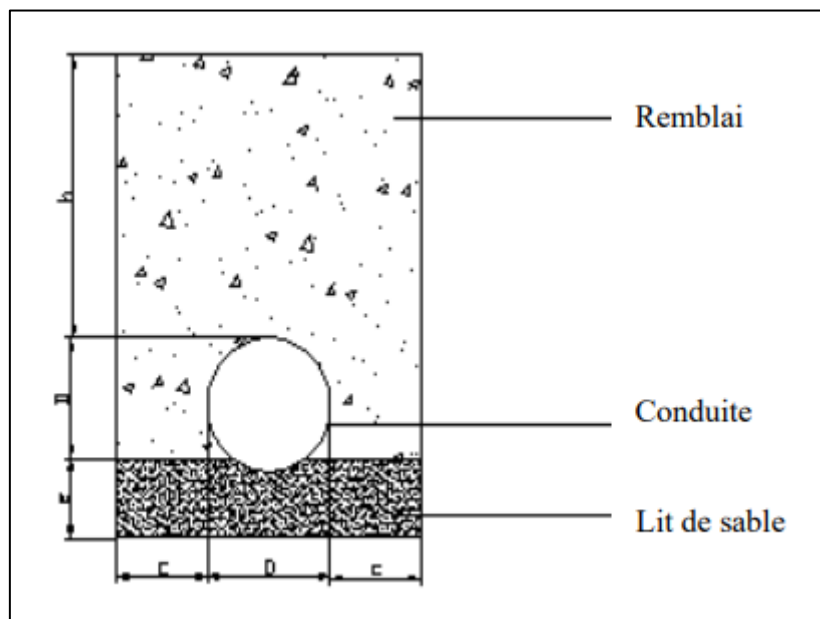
coupe transversale d'une tranchée avec la mise en place de la conduite
